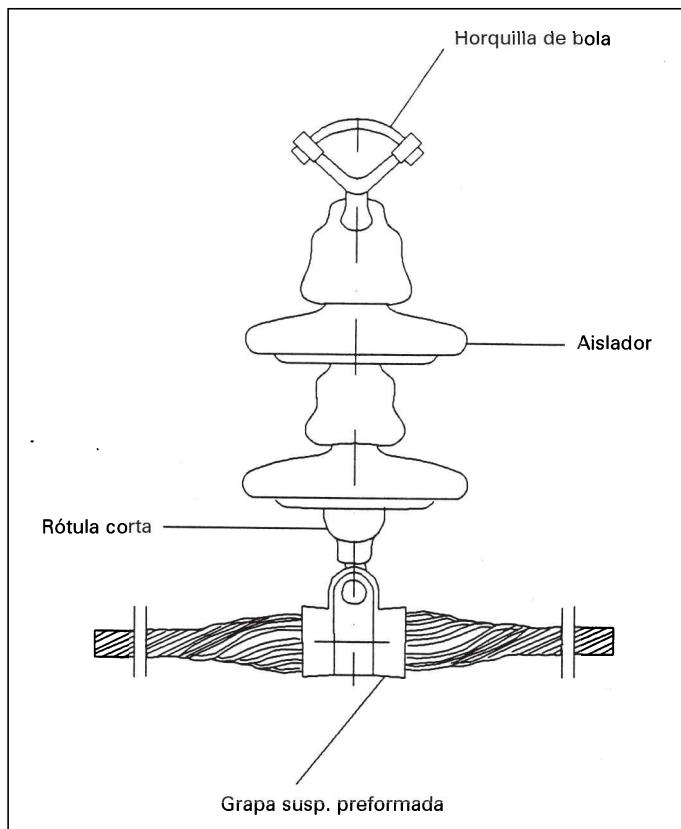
Cadenas de suspensión-cruce con aisladores de vidrio.
